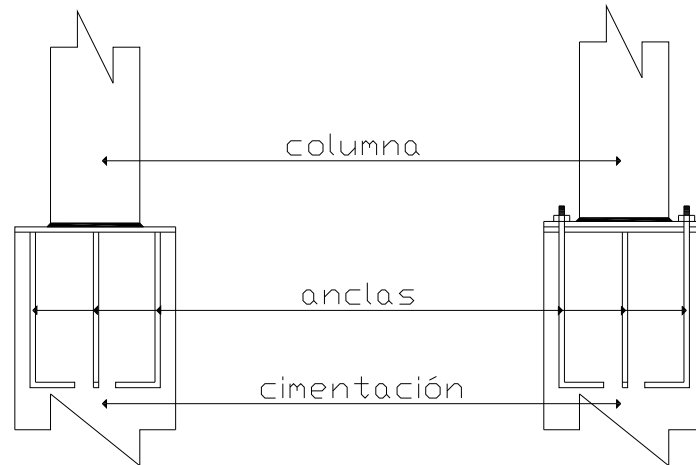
Placa base soldada. Placa base atornillada.
